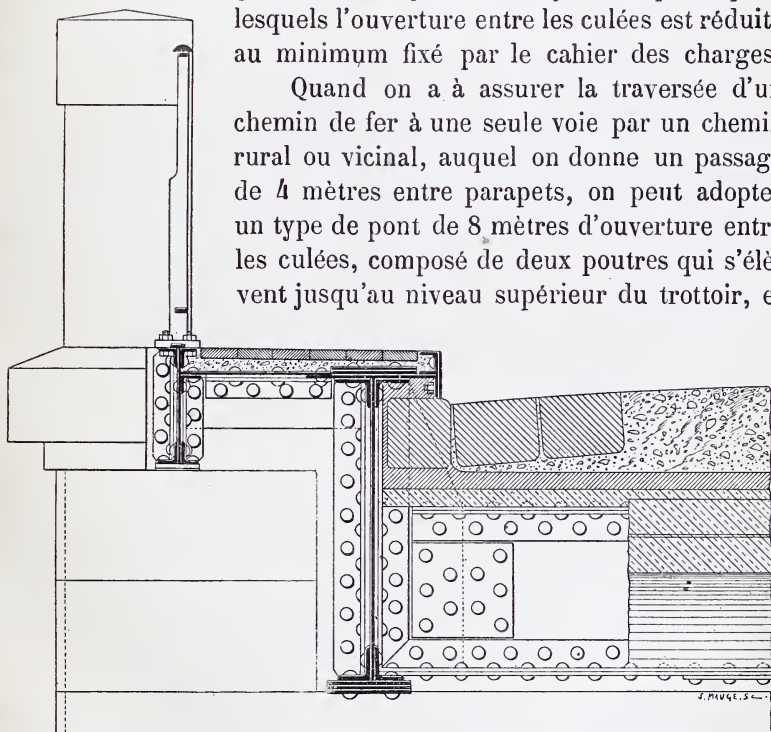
Type de pont pour route de 6 mètres. (Demi-coupe transversale.)
